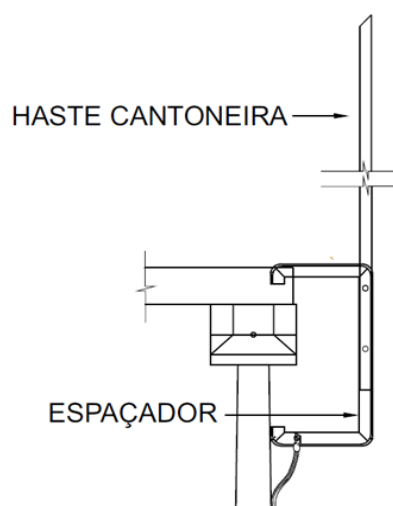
Instalação de haste cantoneira como captor fixado em espaçador de rede de baixa tensão.
